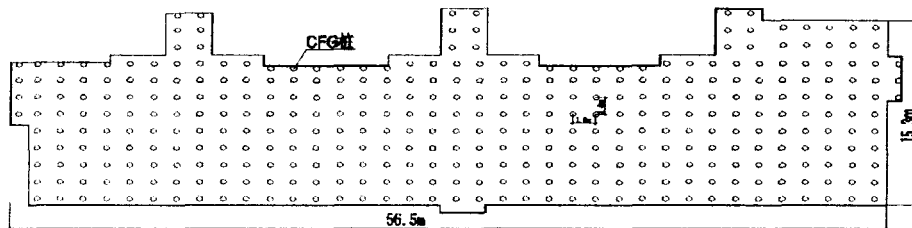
北京北郊某住宅小区5^楼CFG桩平面布置图
